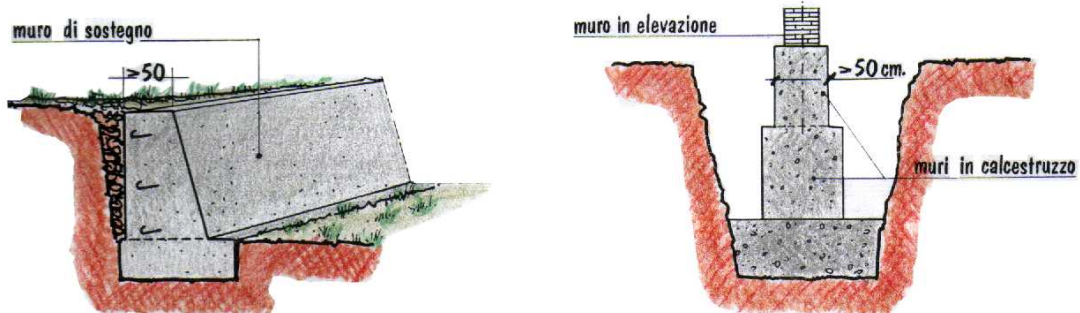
impiego del calcestruzzo per muri di sostegno e murature di fondazione
